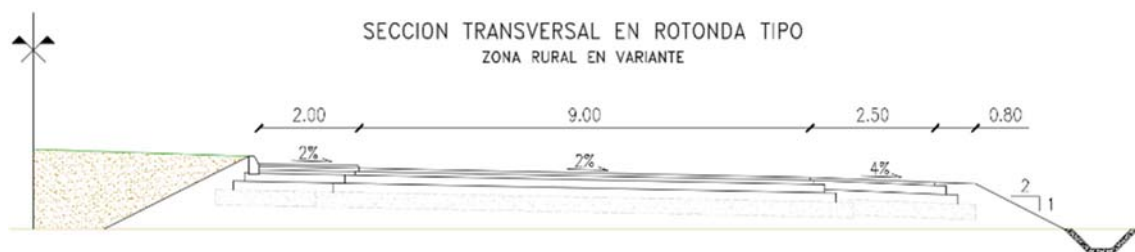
Perfil tipo de obra básica para rotonda de radio R=24m
